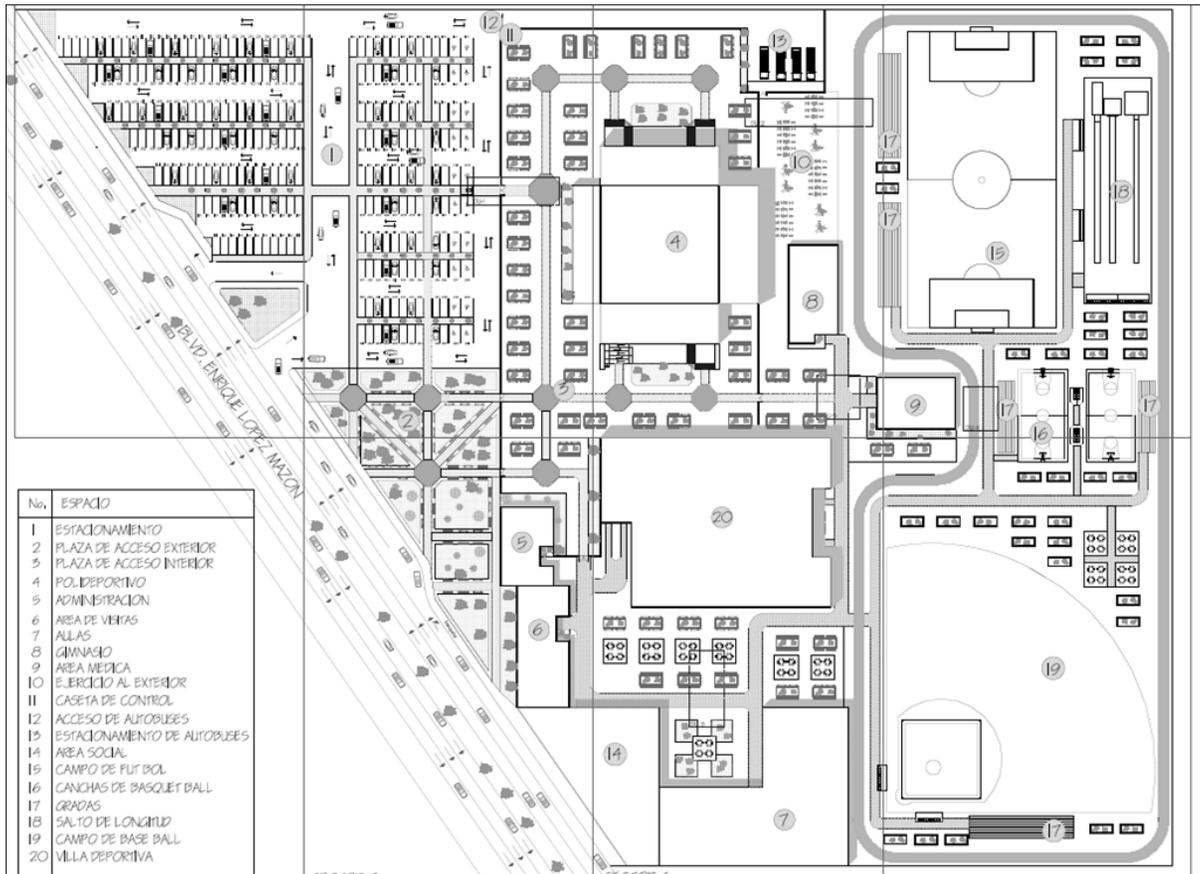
Anteproyecto arquitectónico de conjunto
